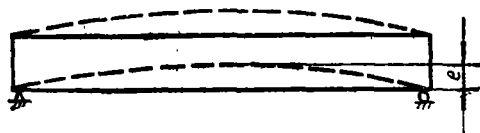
实线为钢筋混凝土梁,虚线为预应力混凝土梁
